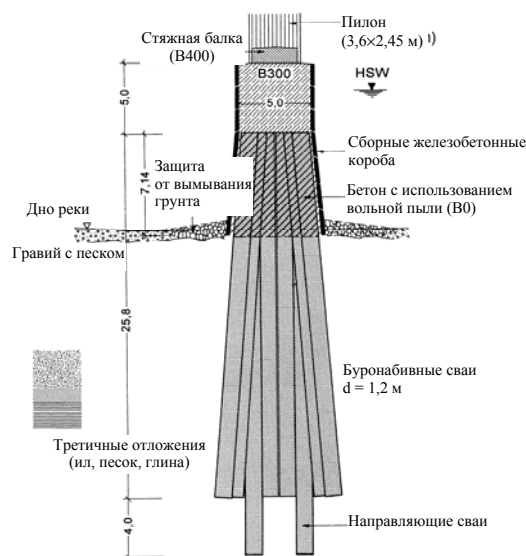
Продольный разрез коробчатого фундамента на наклонных сваях (для опоры моста)
